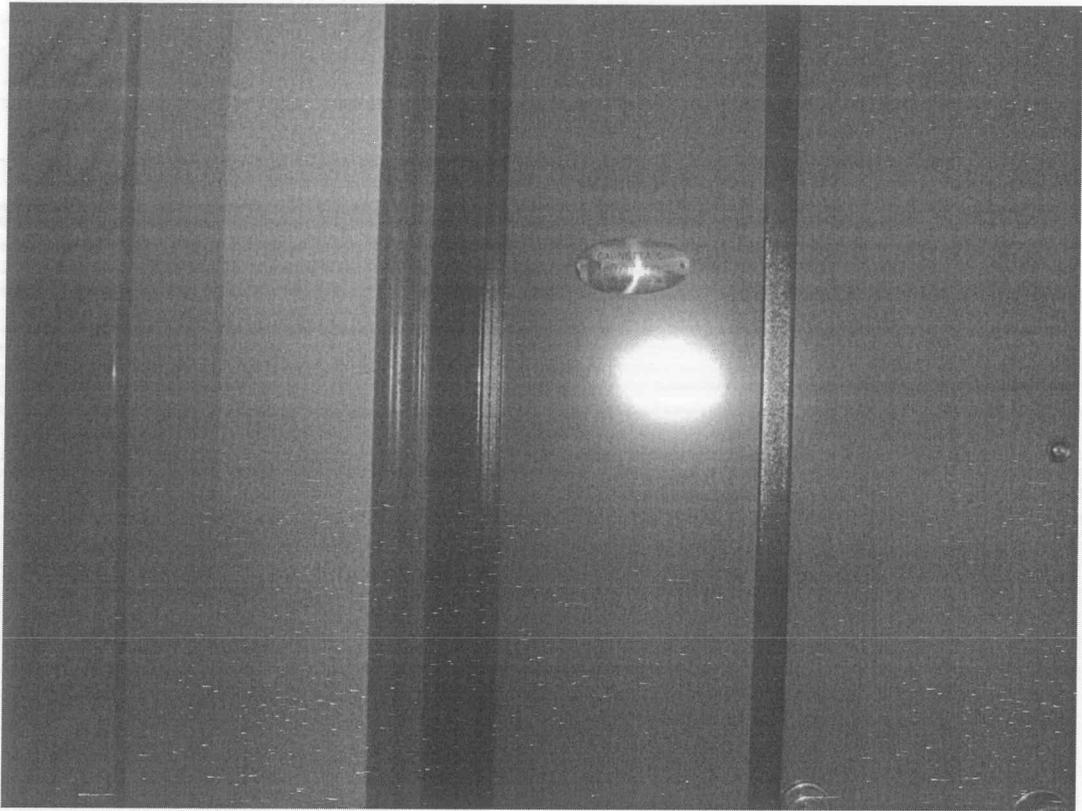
e A2 - Particolari della porta di ingresso e del ingresso dell'alloggio
